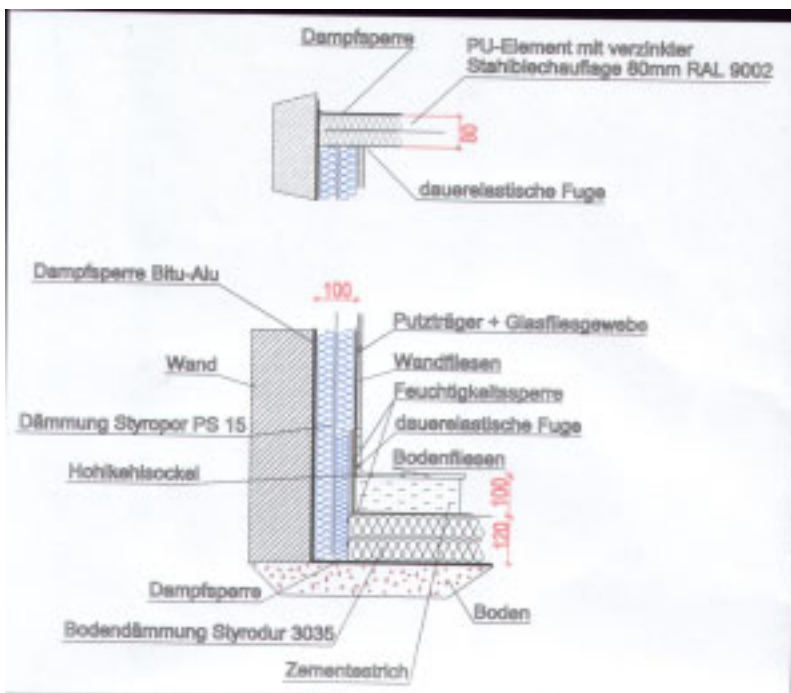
Schnitt Boden- Wandanschluss, Konventioneller Kühlraum
